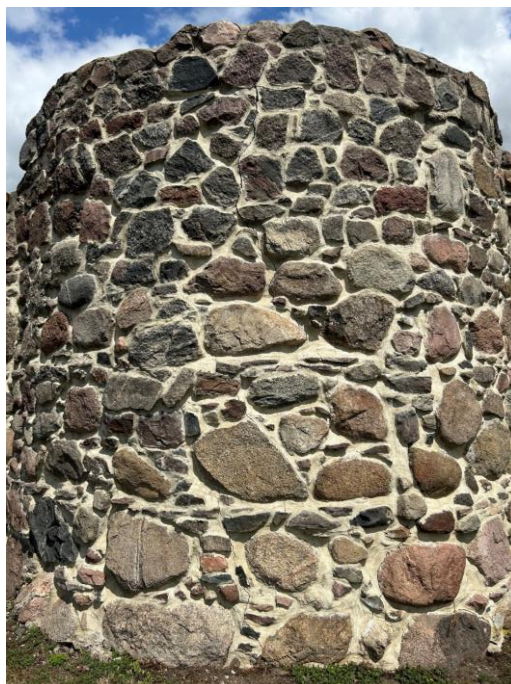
Baszta łupinowa nr VIII w ciągu zabytkowych murów obronnych – widoczna deformacja muru w kierunku południowym, a także wydatne pęknięcia zlokalizowane na styku z przyległą kurtyną muru (widok od strony wschodniej)
